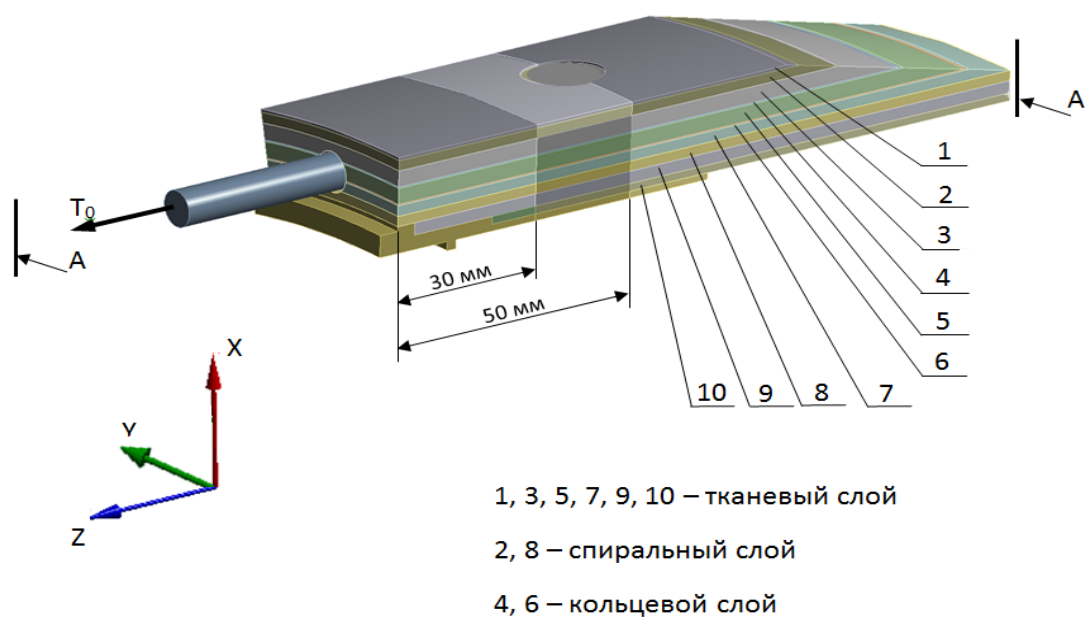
Расчетная модель конструкции корпуса из КМ с ШШС
